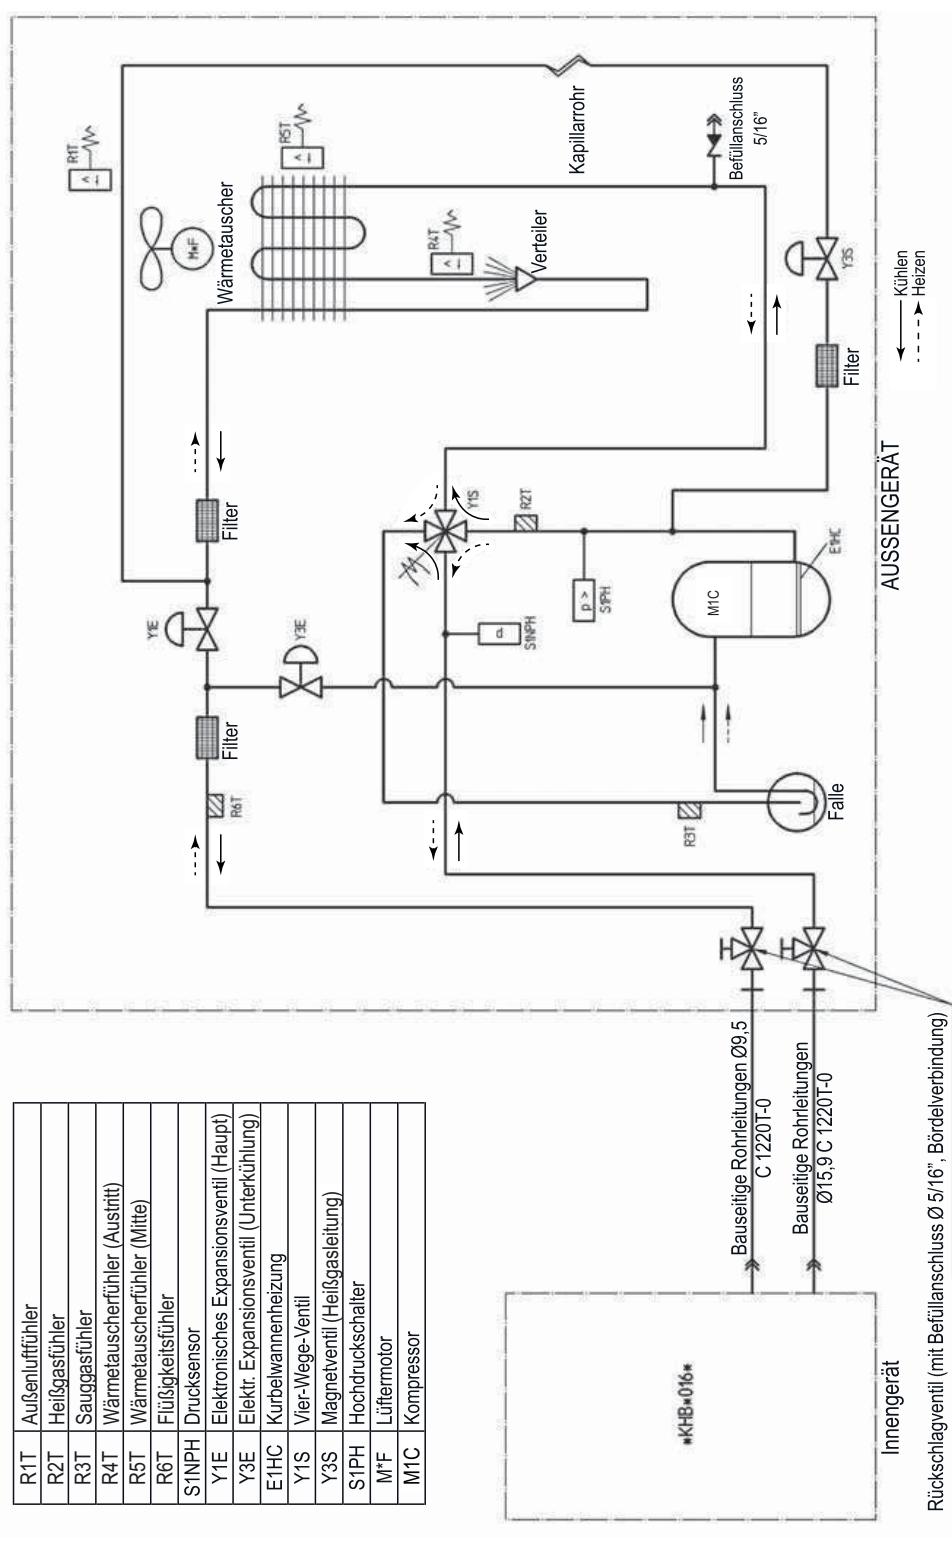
Kältetechnischer Aufbau - Außengerät RRLQ0(11/14/16)
